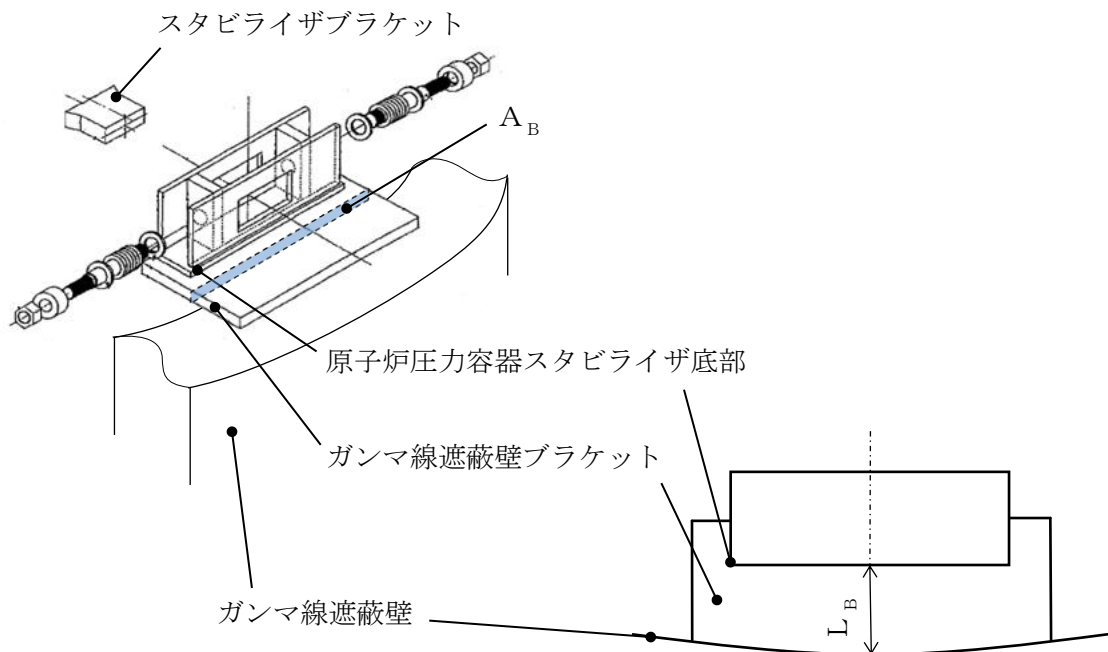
ガンマ線遮蔽壁ブラケット概略図
